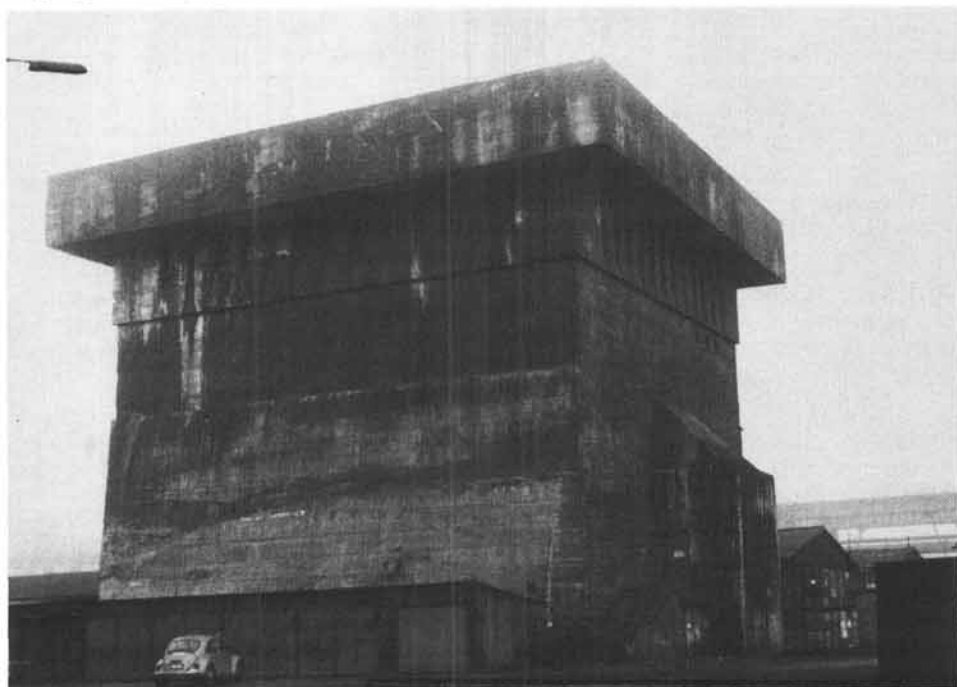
Hochbunker in den ehemaligen Eisenwerken Oberdonau. Die abgesetzte Decke in etwa drei Meter Dicke besteht aus massivem bewehrten Beton.
